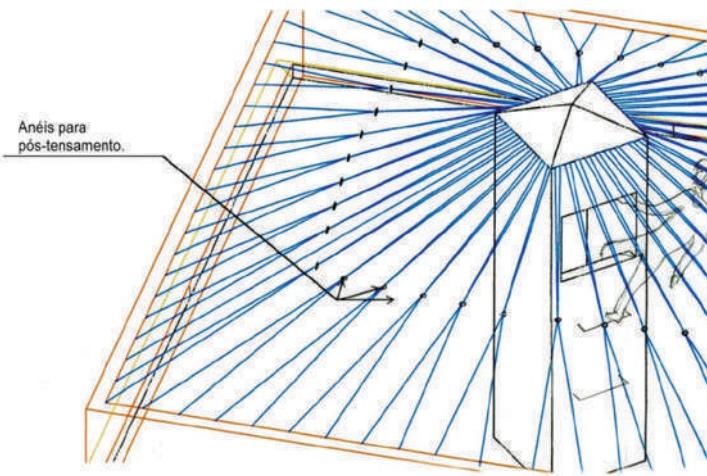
Detalhe do conjunto das armaduras e seu pós-tensamento com os anéis. As armaduras estão ancoradas na cabeça do pilar de concreto e na parede de cerâmica armada. (*-5).
